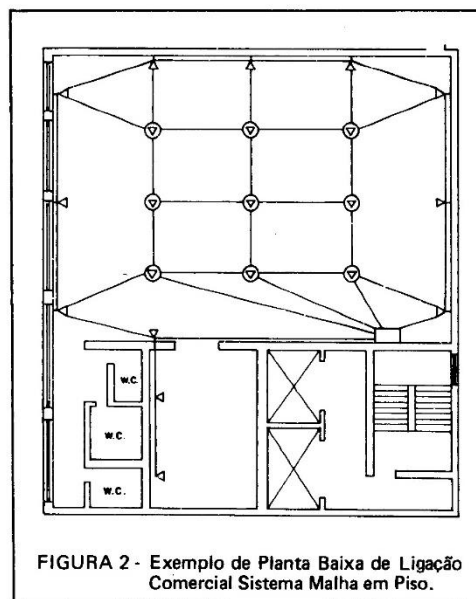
Exemplo de Planta Baixa de Ligação Comercial Sistema Malha em Piso.
